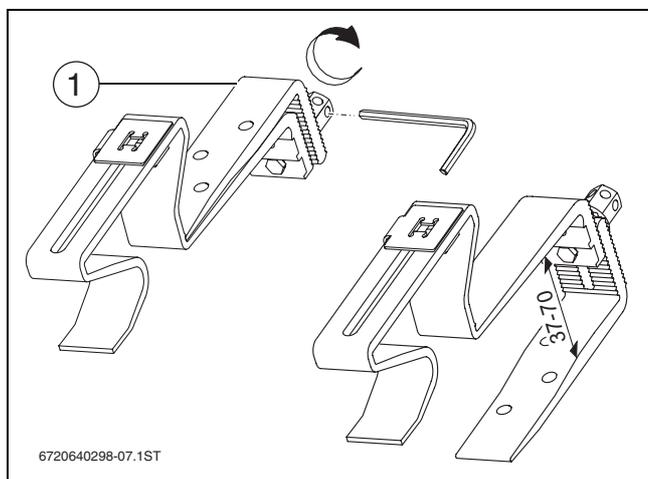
Rodar a parte inferior do gancho para telhados, medida em mm
